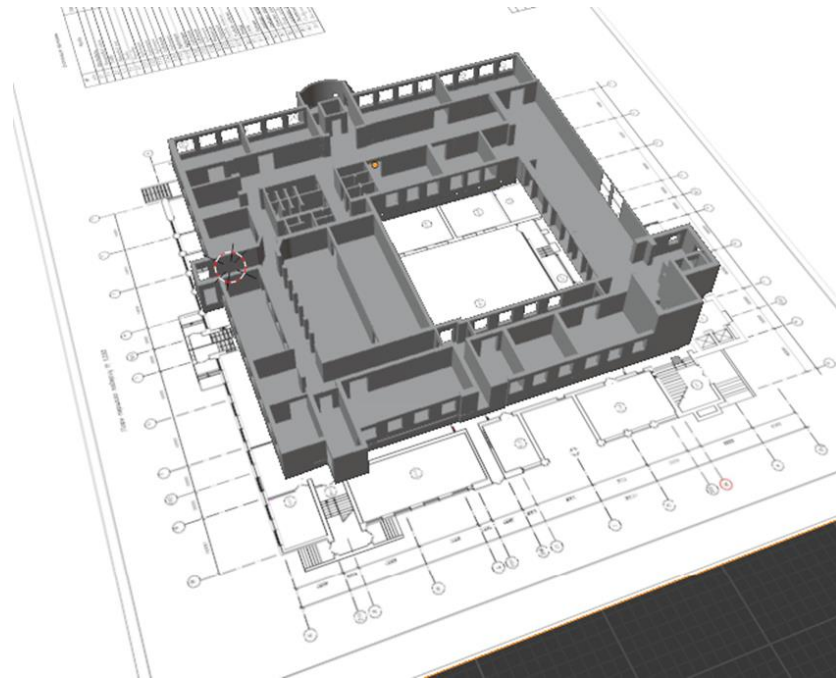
Перший поверх нового корпусу зведений у Blender
